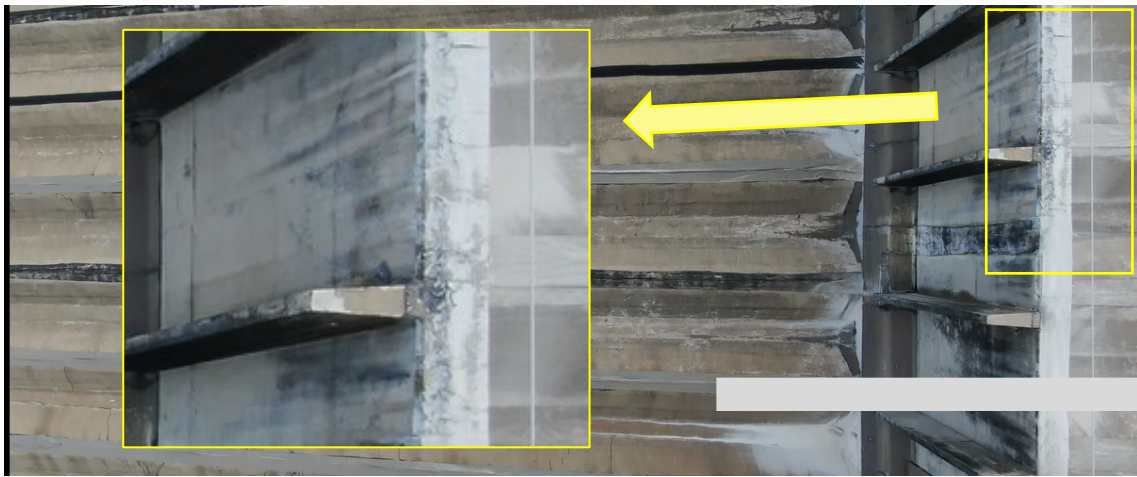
Descamação superficial na parede de concreto e fissuras,
